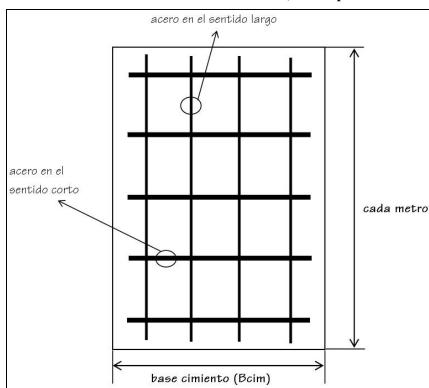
Detalles de armado de un cimiento corrido (armado por cada metro lineal)
